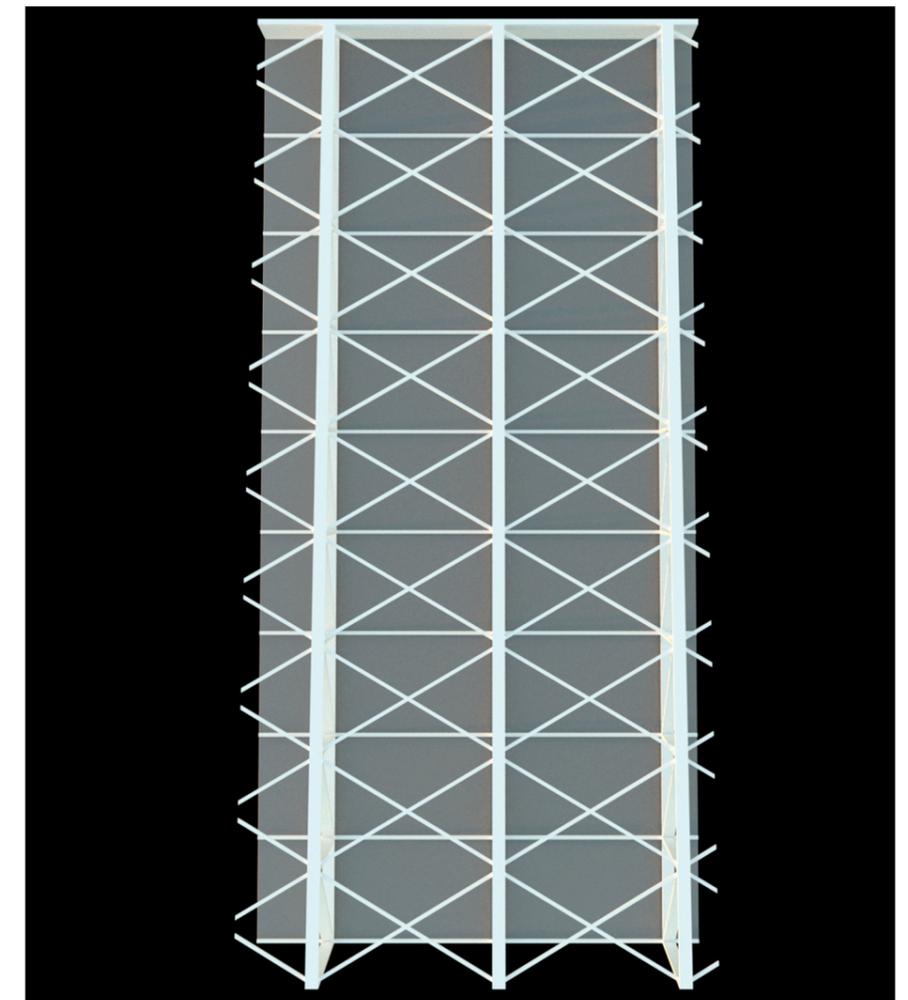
Renderización en planta inferior de la cubierta de la propuesta, donde se aprecian sus elementos. Elaboración propia.
